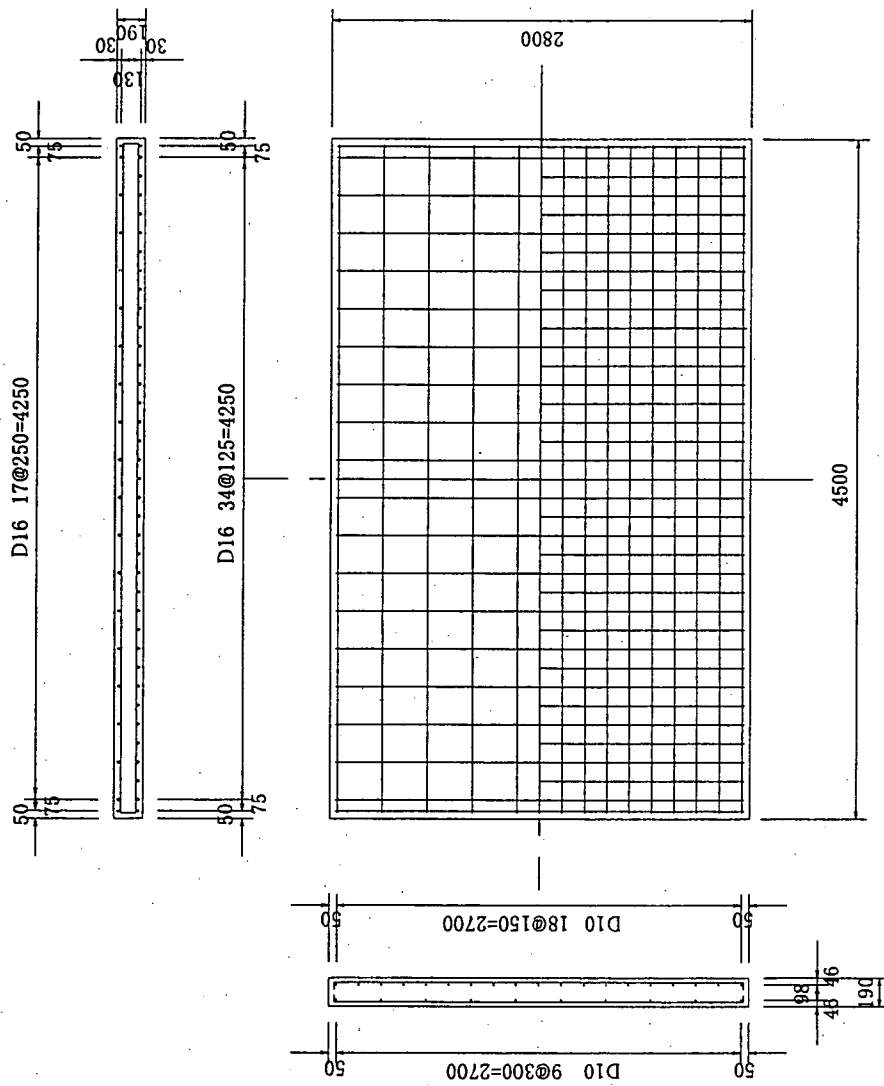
RC39-2供試体の形状・寸法 (単位:mm)
